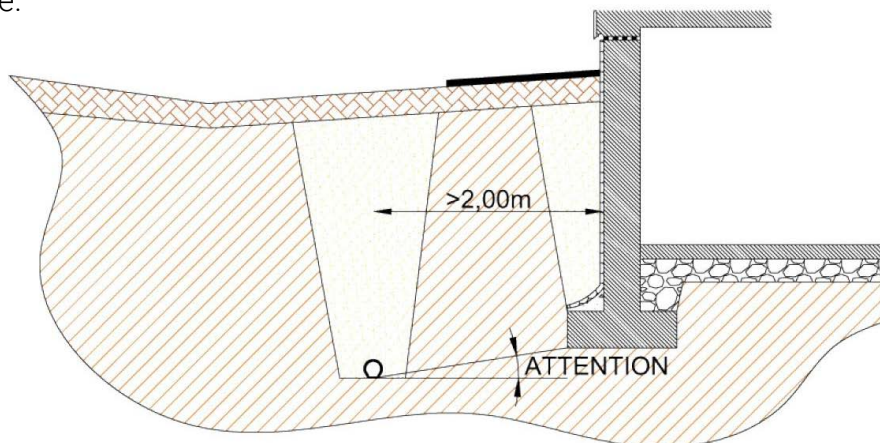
POSITIONNEMENT A DISTANCE DES FONDATIONS
